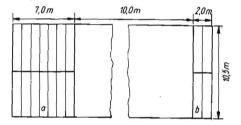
Prinzipschema des kompletten Weidemelkhauses;
